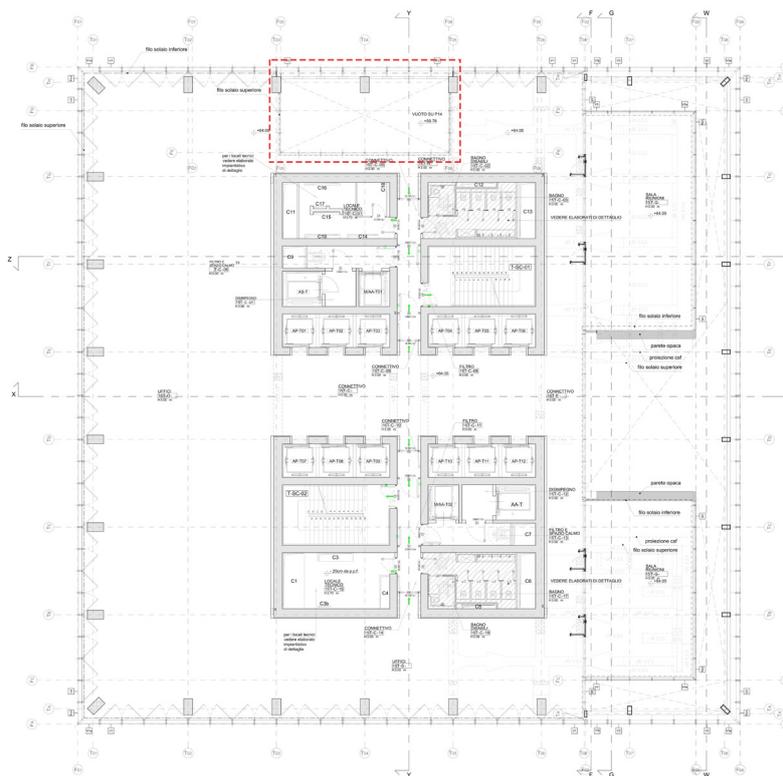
pianta piano 14 - Elaborato tecnico PR\_3\_C\_A\_P\_T0217\_03
